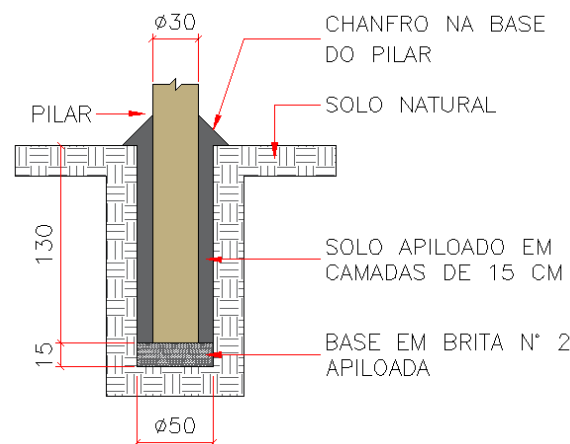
ESQUEMA DA FUNDAÇÃO PARA OS PILARES
